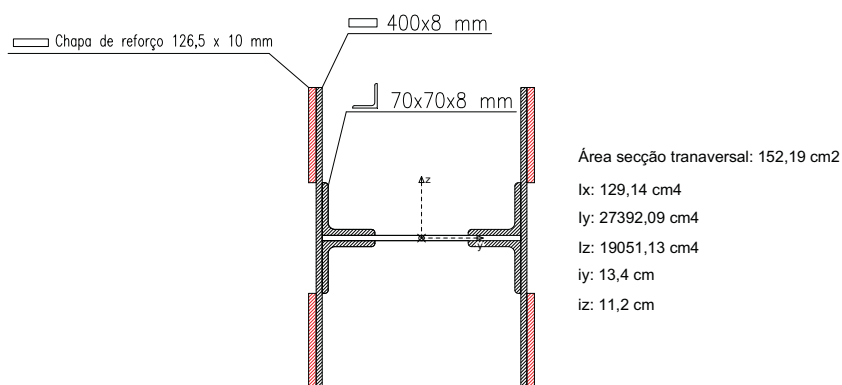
Reforço do elemento CI3 e CI4 da viga principal.
